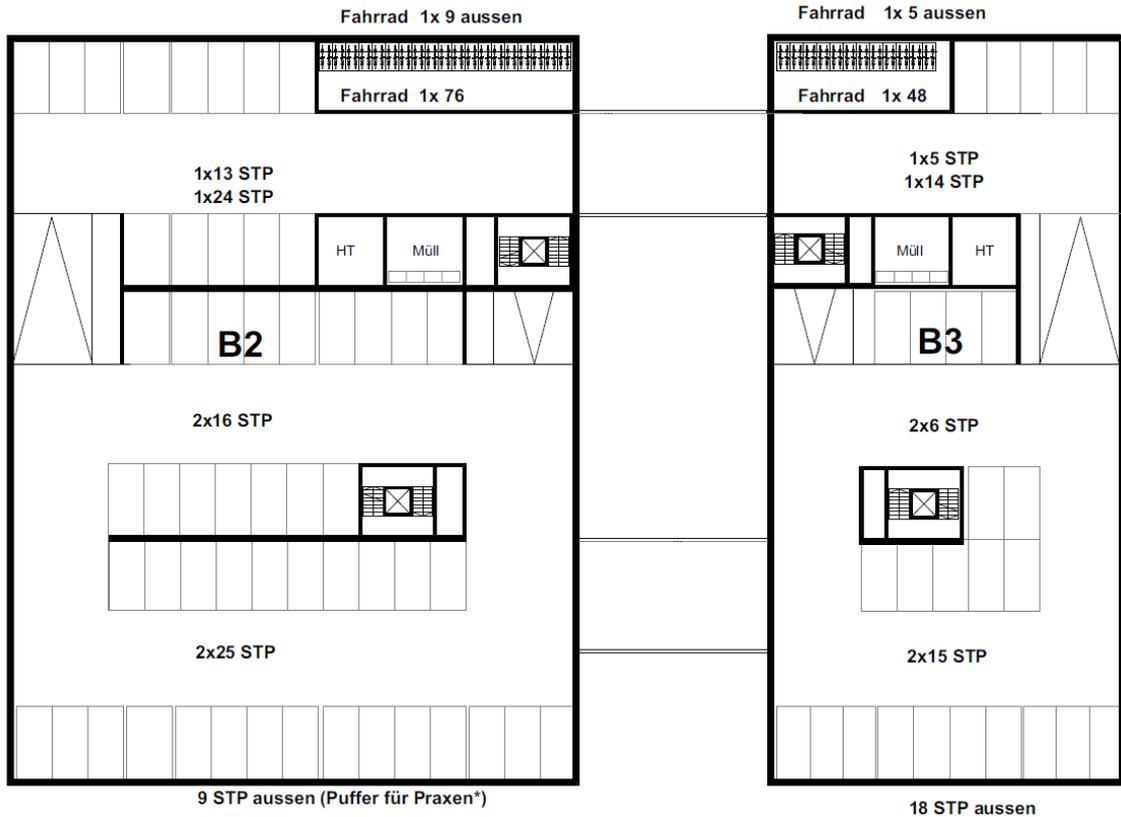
Grundrisssskizze Tiefgaragen der Gebäude B2 und B3
